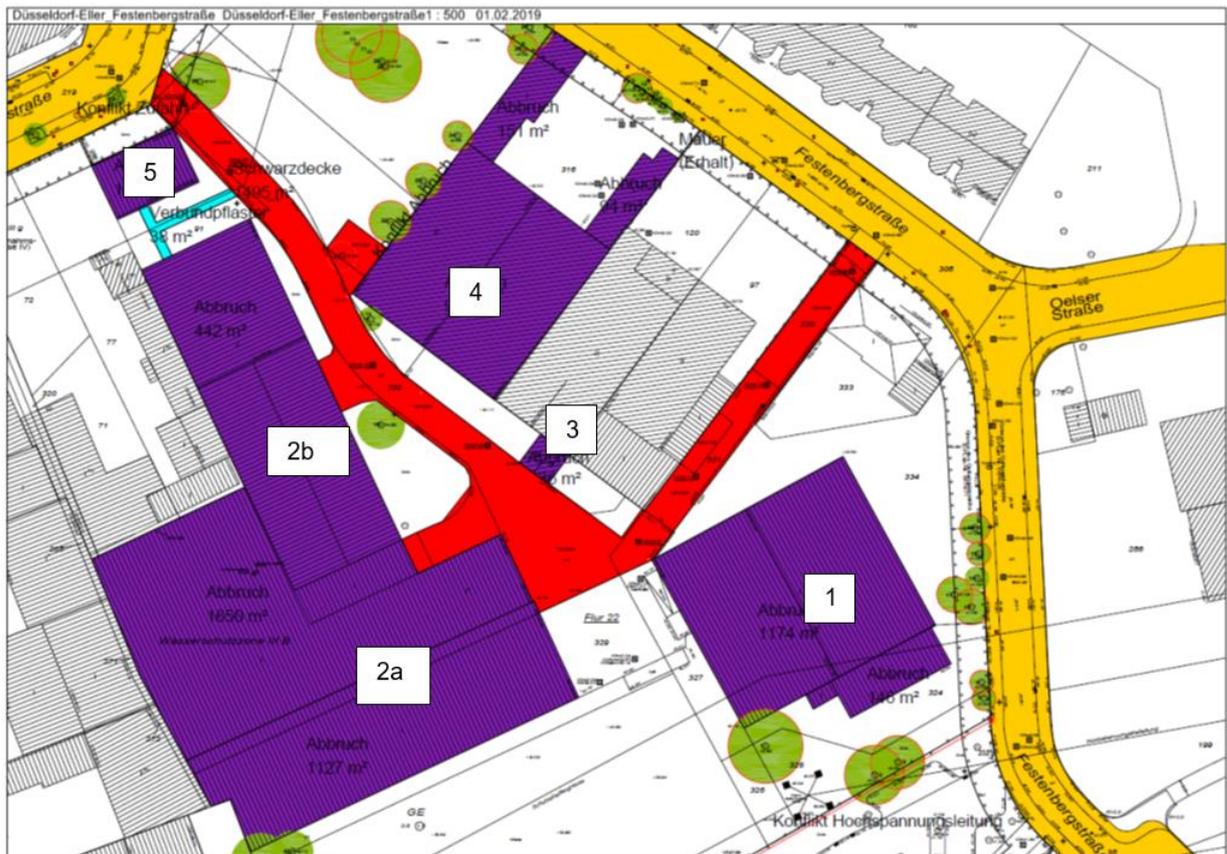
Abbruchplan mit Nummerierung der Abbruchgebäude (die im Text beibehalten wird)
